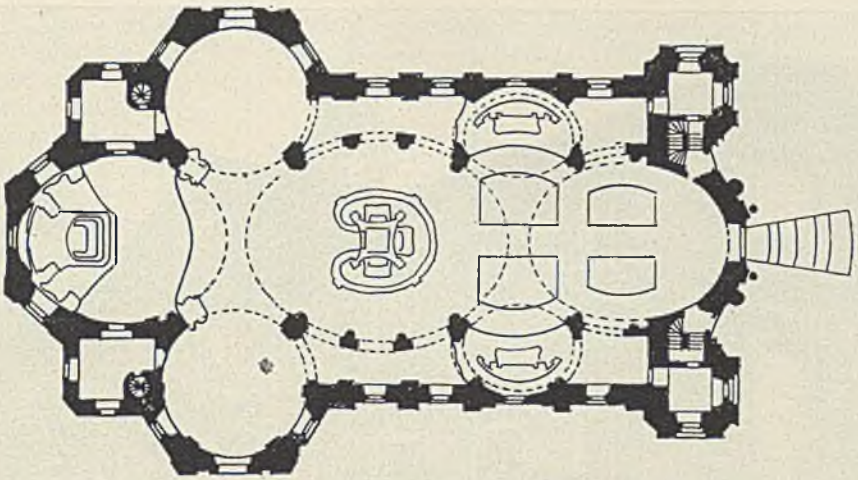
Grundriß der Kirche zu Vierzehnheiligen
